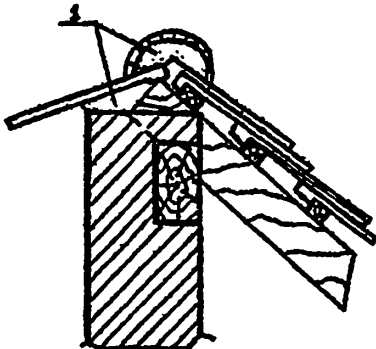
Вариант покрытия конька односкатной кровли каменного здания
